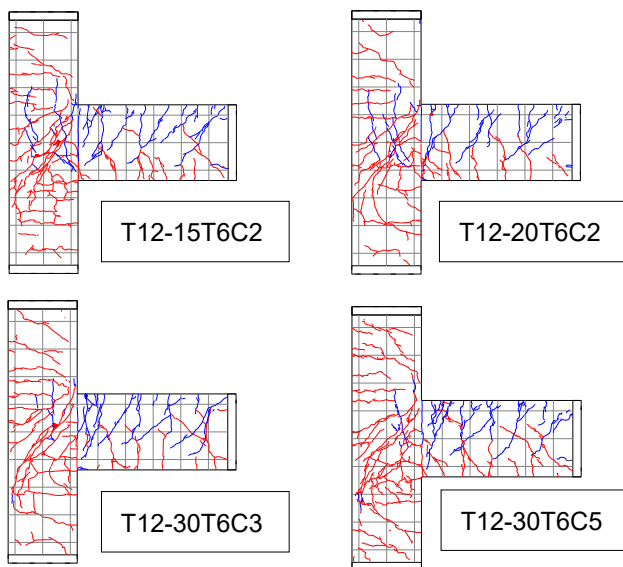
1/50rad.時ひび割れ図 (青：正加力時，赤：負加力時)
